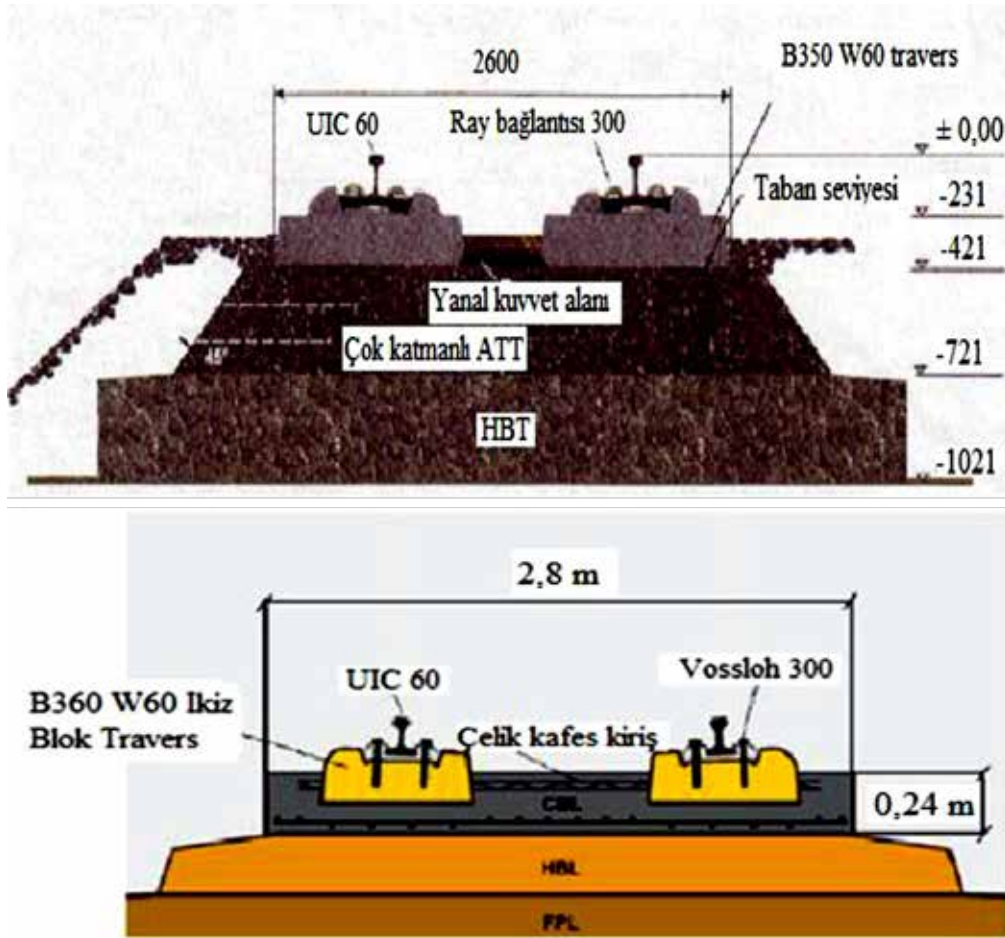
İkiz blok traversli Züblin tipi üstyapı
